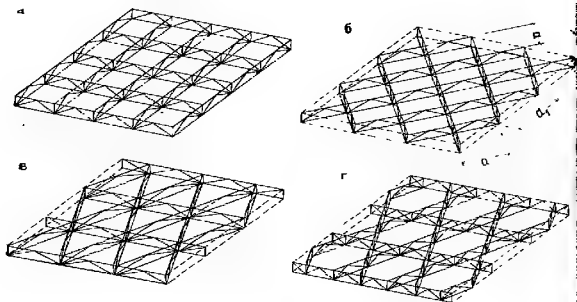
Схемы покрытий из вертикальных перекрестных ферм
